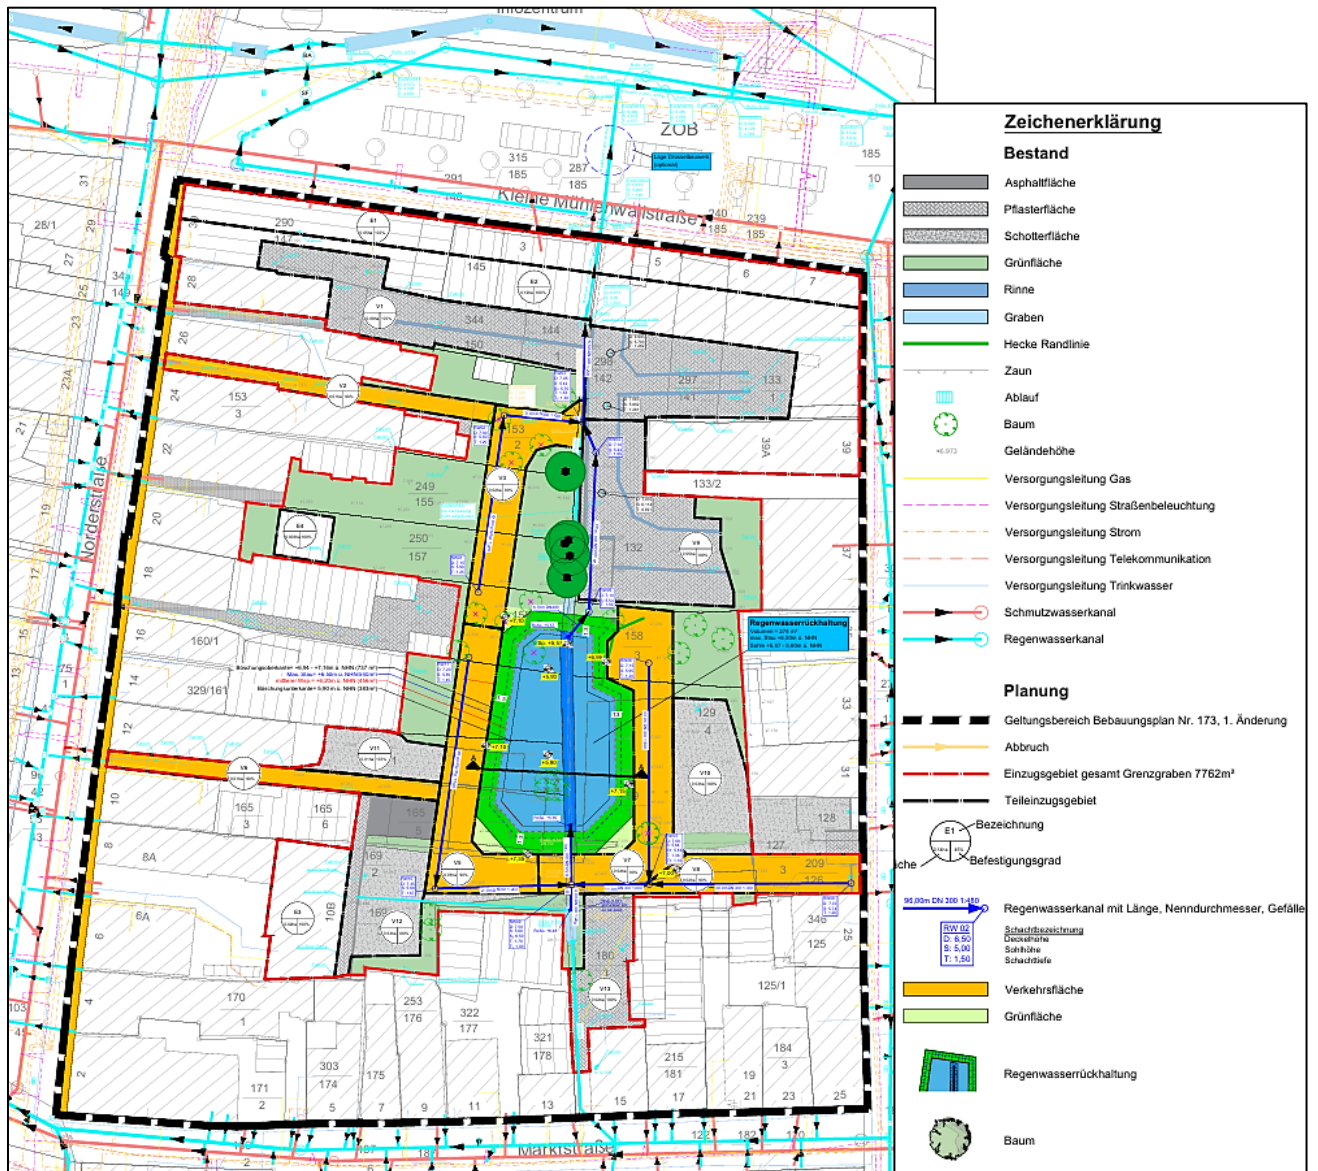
Entwässerungsplanung mit RRB (Ing.- Büro Born & Ermel 2025).
